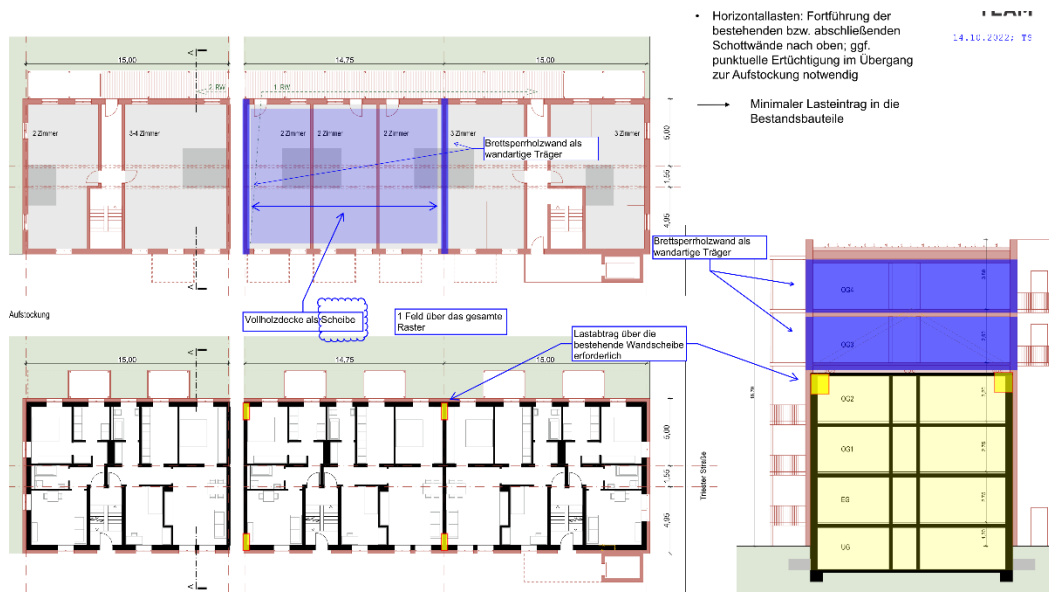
Lastabtrag der Horizontallasten, Sailer Stepan Tragwerksteam
